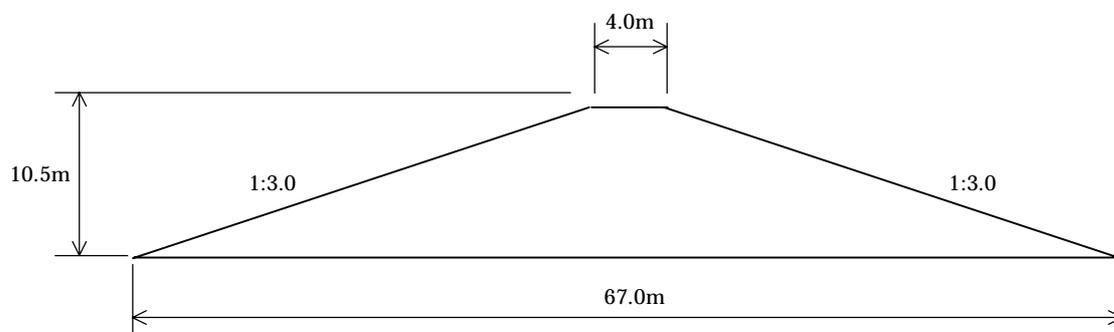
HoThanh 溜池堤体の標準断面
